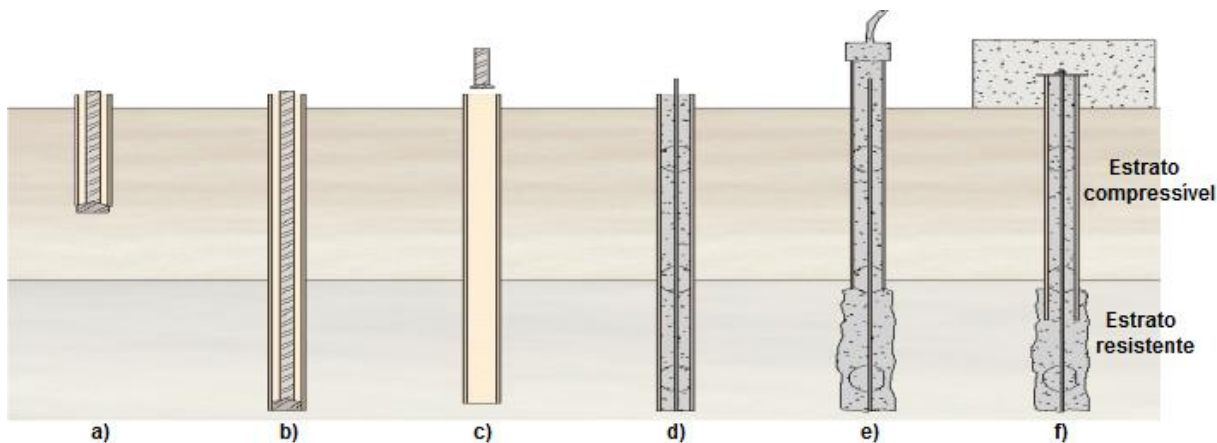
Processo de execução de microestacas moldadas: a) início da furação; b) furação até à cota pretendida; c) retirada do equipamento de furação; d) colocação da armadura e injeção da calda de cimento de preenchimento; e) injeção a alta pressão; f) maciço ou viga de encabeçamento [4]
